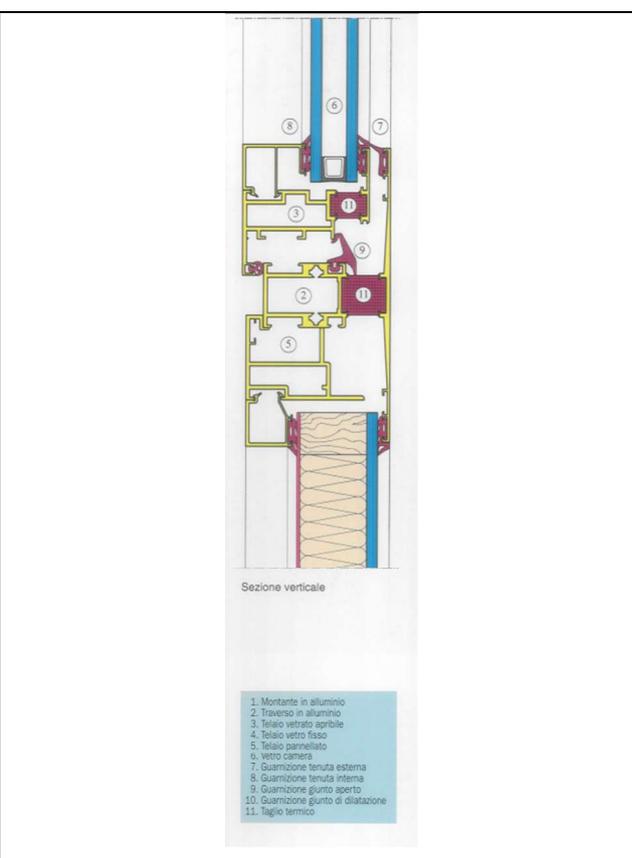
Schema infisso estratto da brochure ditta Focchi realizzatrice infissi (sez. verticale)
